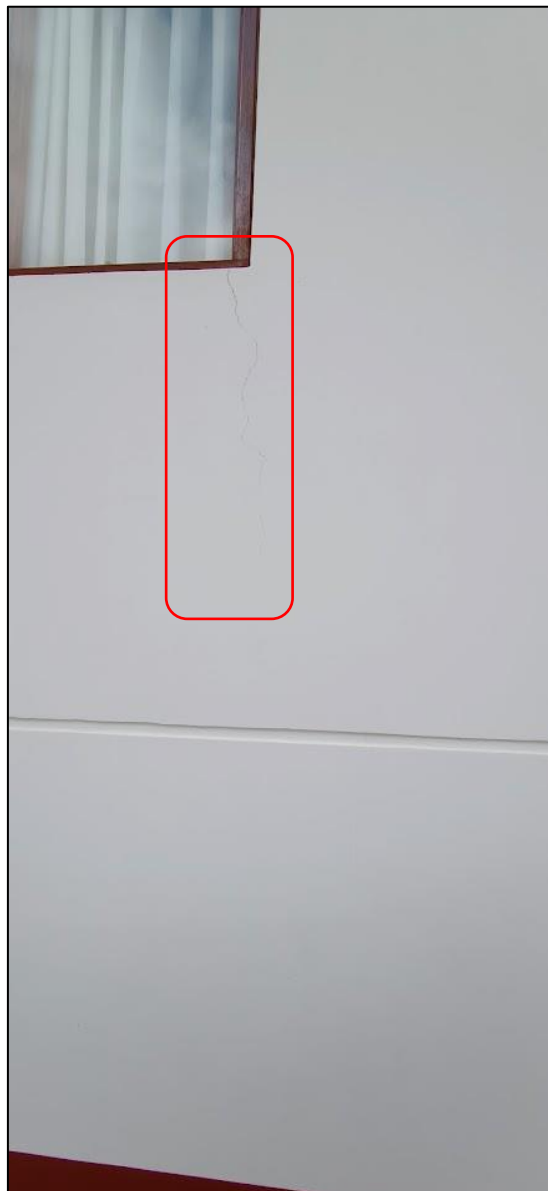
Vista de fisura vertical en muro de fachada oeste.
